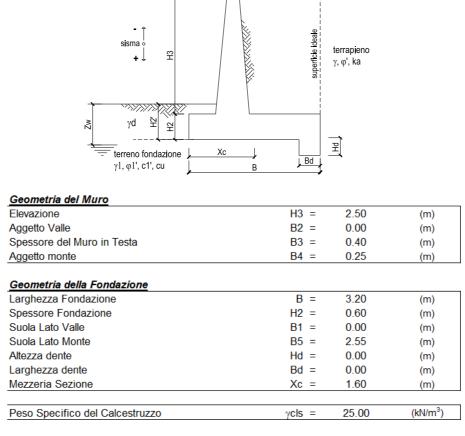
Caratteristiche geometriche muri di sostegno con fondazione diretta – tipo 1.
